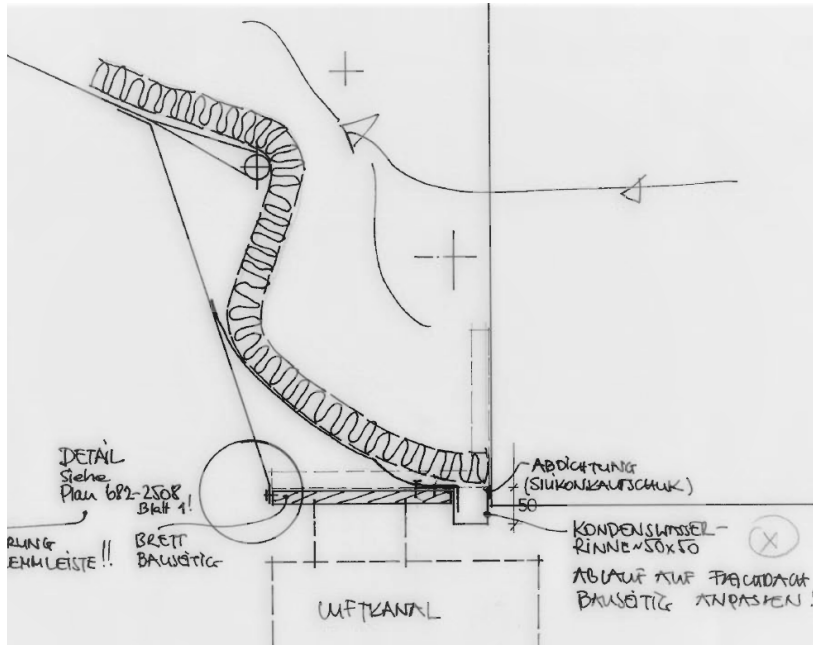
TOM Dortmund, Dachranddetail mit Entwässerungskanal
